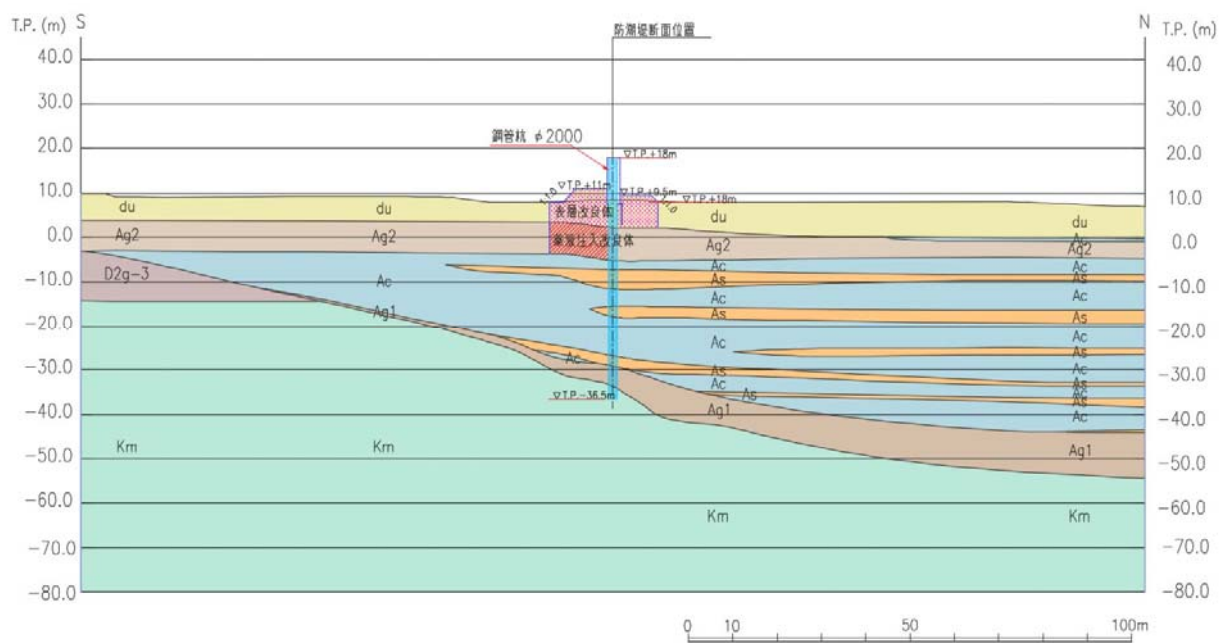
地震応答解析対象断面図 (断面⑤)
